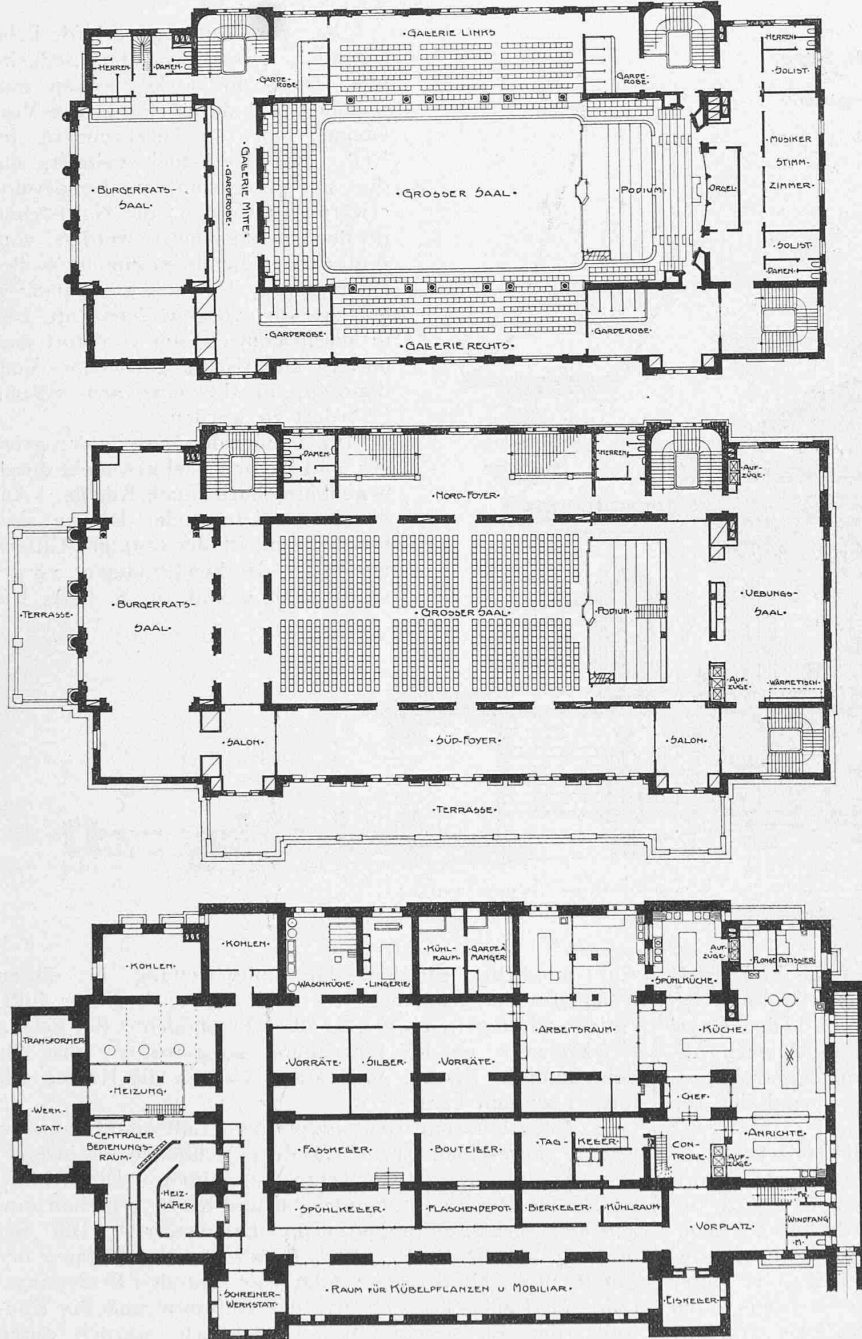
, 3 und 4. Grundrisse vom Keller, I. und II. Stock. — Masstab 1 : 600.
